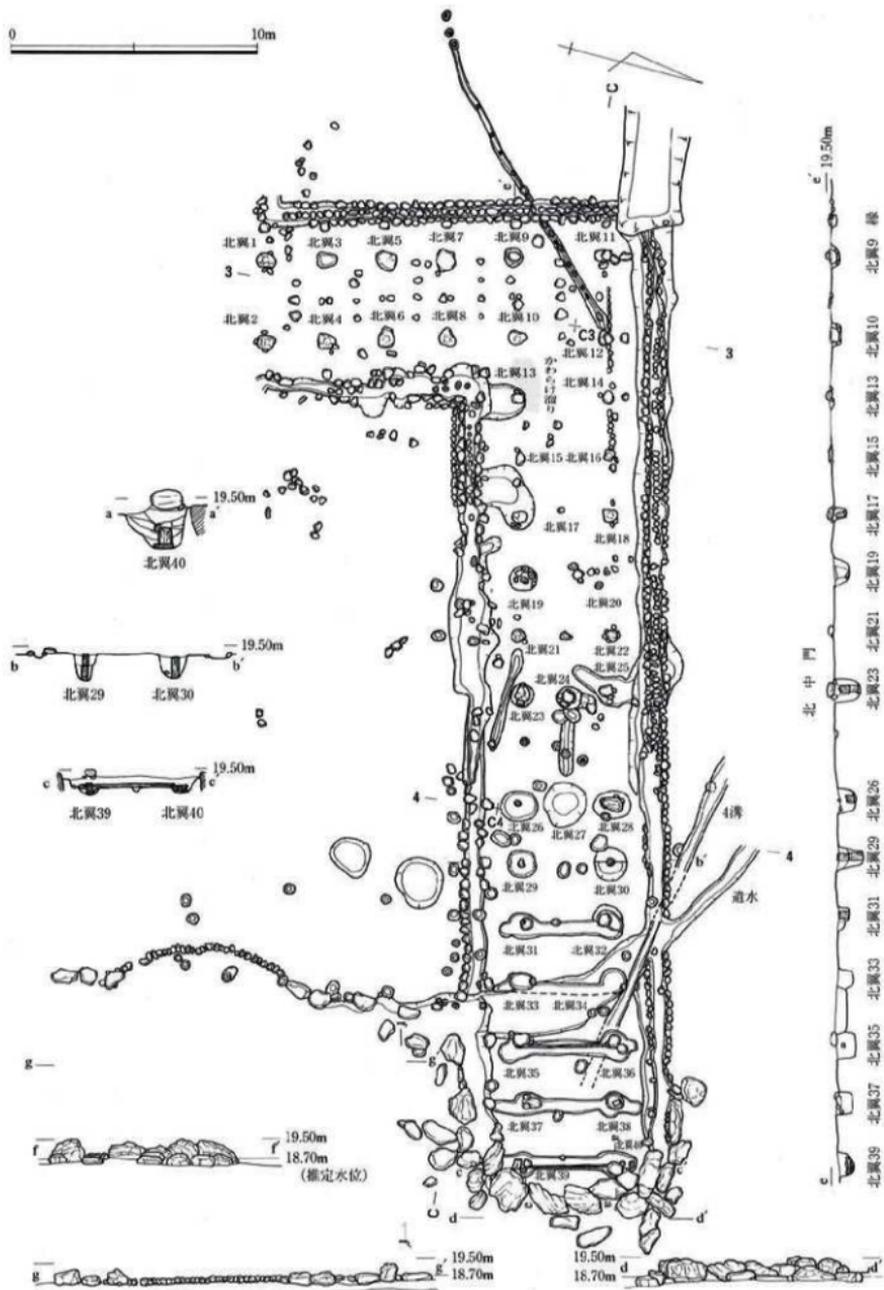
北翼廊平面図・礎石掘方見通し断面・疊石立面図
